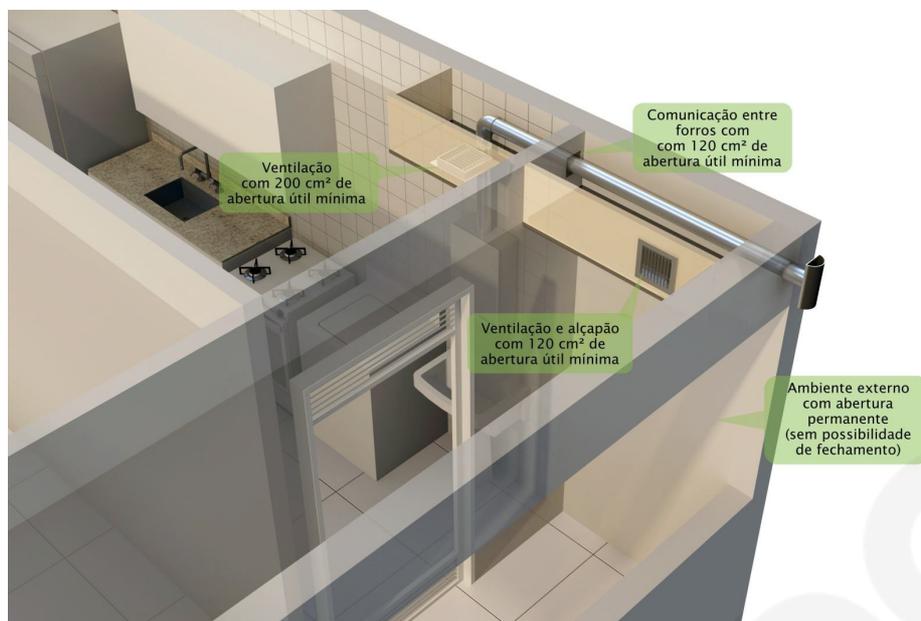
Duto de exaustão instalado em forro com passagem em viga.
